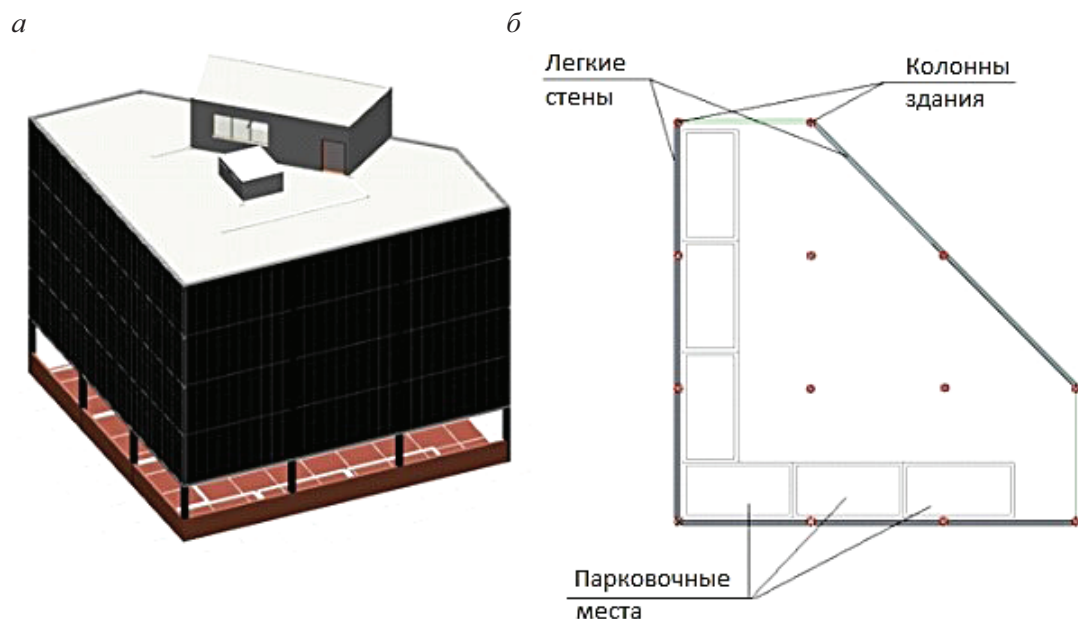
Общий вид (а) и план первого этажа (б) здания с открытым первым этажом
